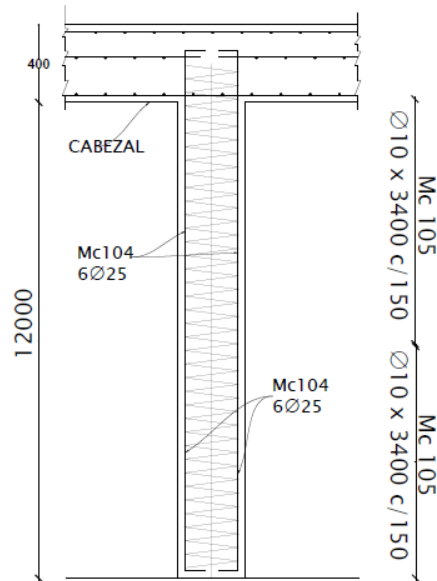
Vista Lateral de Pilotes 12m.
